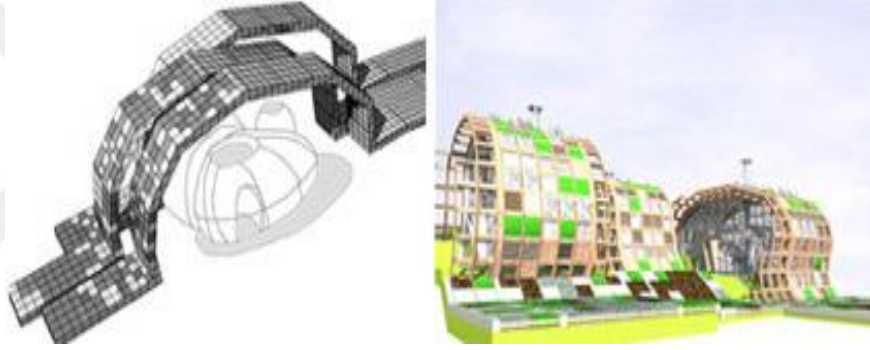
MATscape sistem şeması (Pallan, 2009b)
